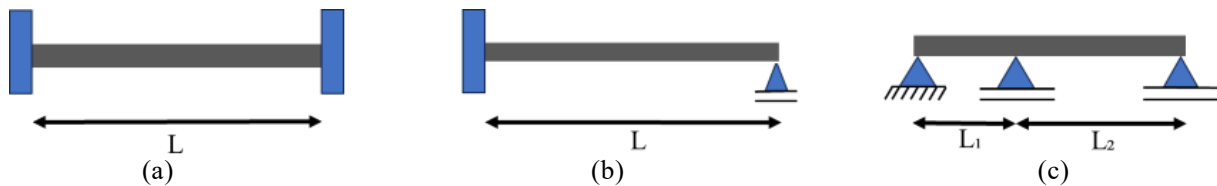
Vigas estaticamente indeterminadas: viga biengastada (a), viga engastada numa extremidade e apoiada na outra (b) e viga contínua (c). Adaptada de [3]
